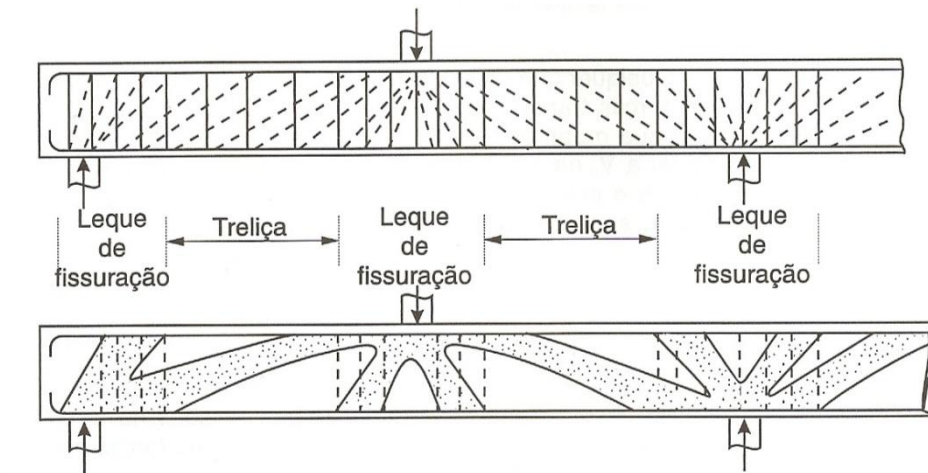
Inclinações possíveis das bielas de concreto baseado na fissuração do concreto (Fusco 1995)
